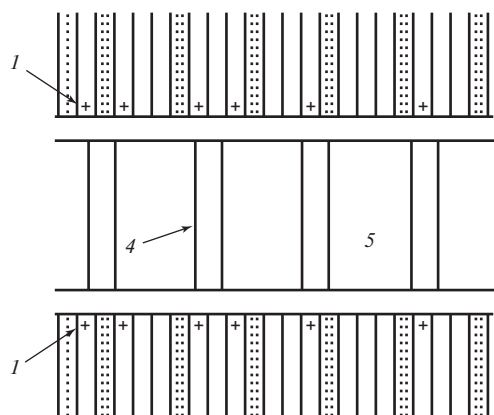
Соединение полос оконного проема с металлическим покрытием фасада:
